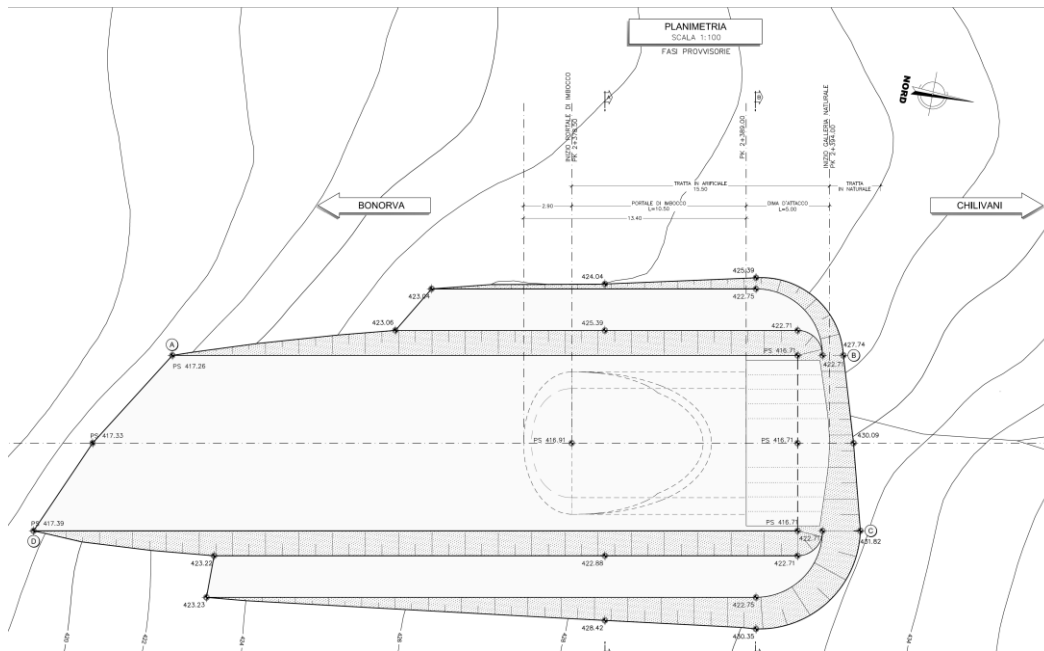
Galleria Giave – Imbocco lato Bonorva – Planimetria in fase provvisoria
